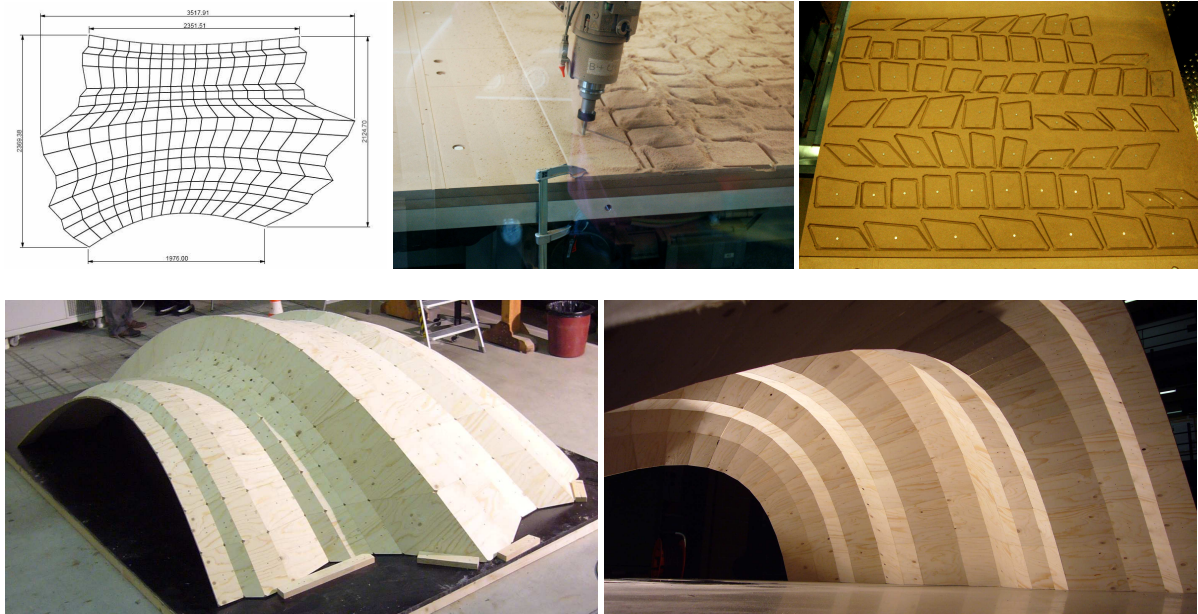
Étude d'application à la construction : plan de fabrication des pièces, et structure en bois assemblée.
